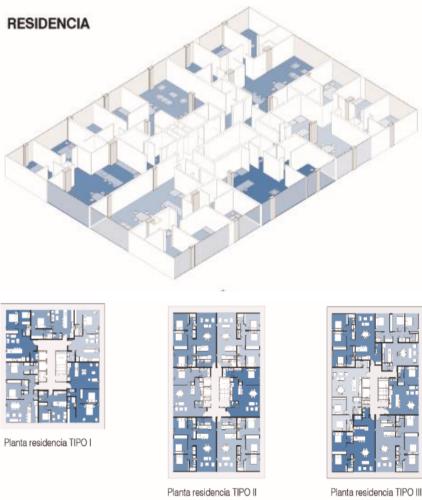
Propuesta de plantas esquemáticas de vivienda
